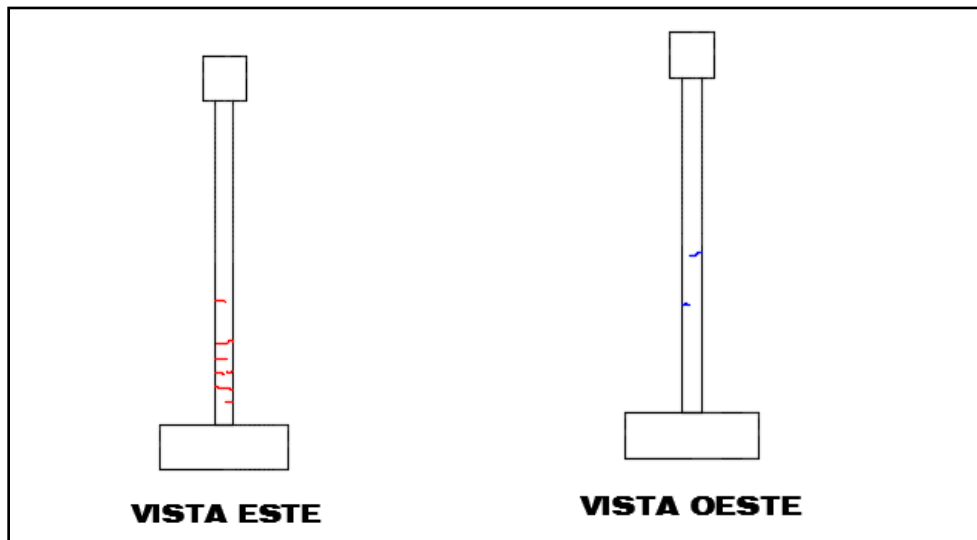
Mapeo de fisuras elementos de confinamiento para una distorsión de 1/1100.
